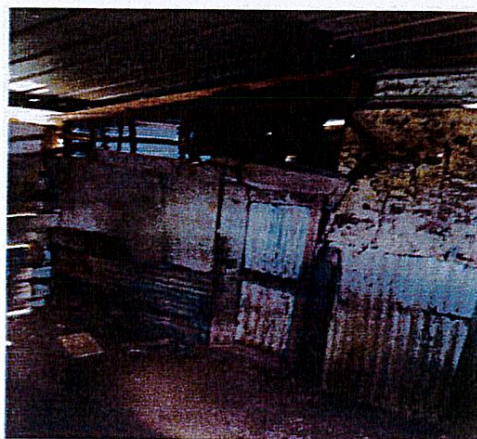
construction formée par assemblage de matériaux hétéroclites en mauvais état.
